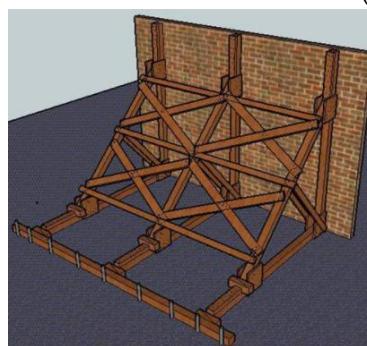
Arriostamiento para refuerzo de muros. Fuente:
